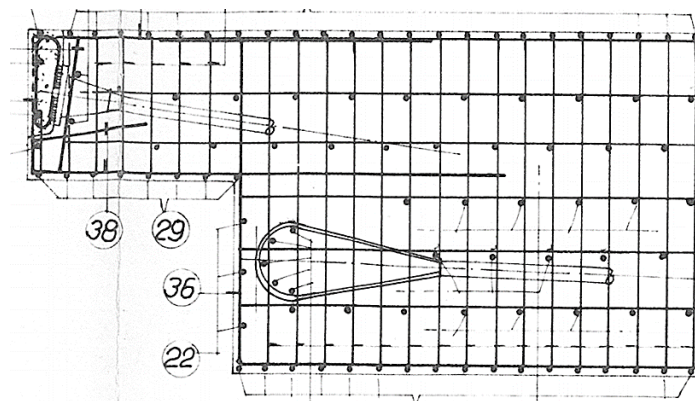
Sezione longitudinale, posizionamento dell'armatura ordinaria
